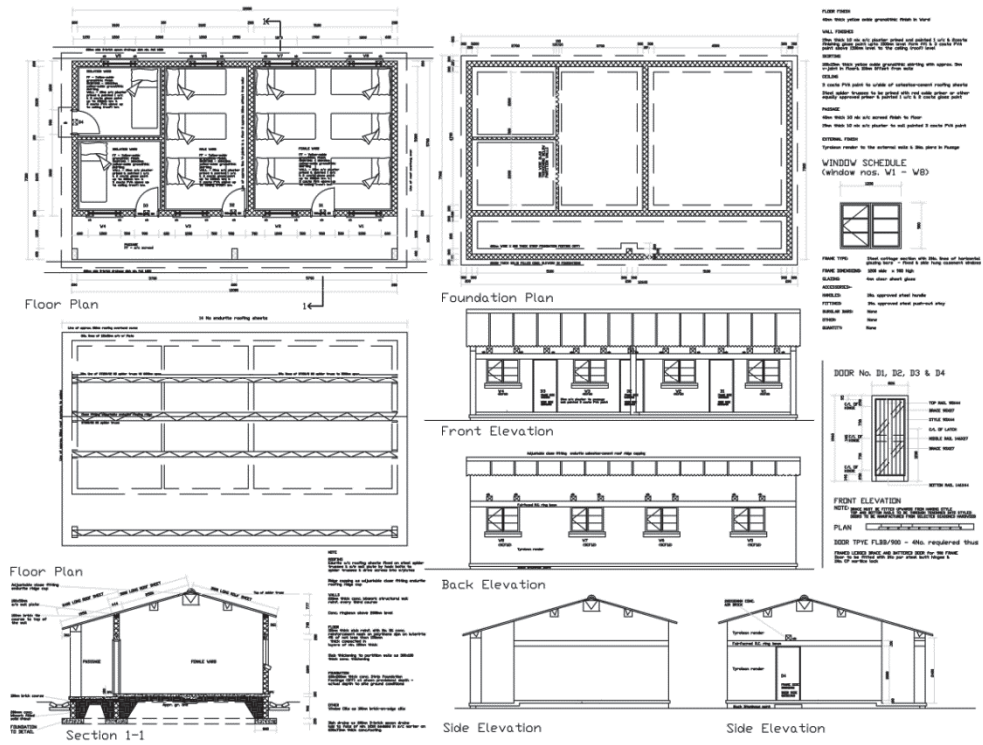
Health Centre 平面图 · 立面图 (IN PATIENT Block)
